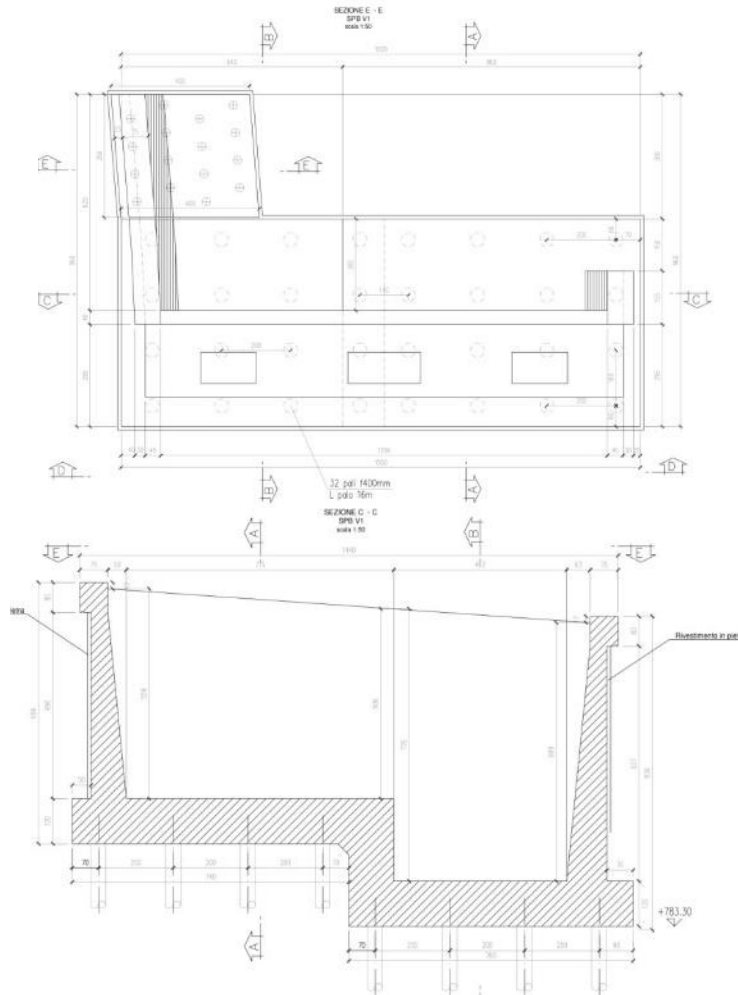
Spalla B: sezione longitudinale e pianta
